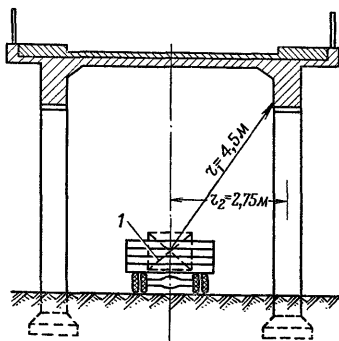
Схема расположения резервного заряда под подрываемым железобетонным путепроводом:
